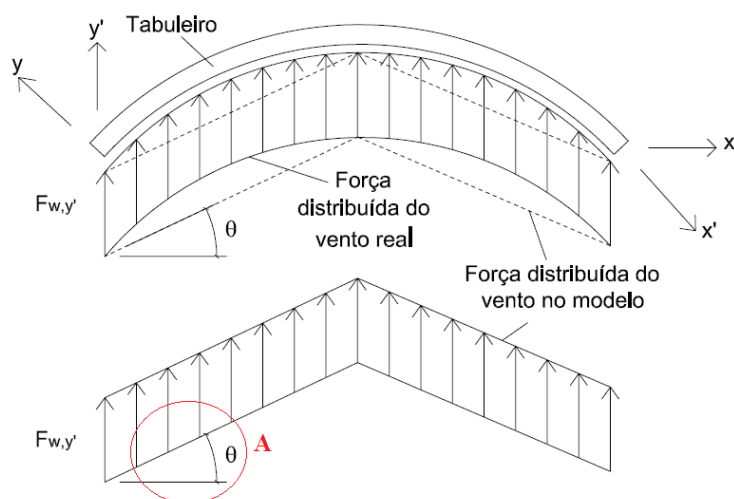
Forças distribuídas devidas ao vento aplicadas no tabuleiro concebido com viga caixão (vista em planta).
